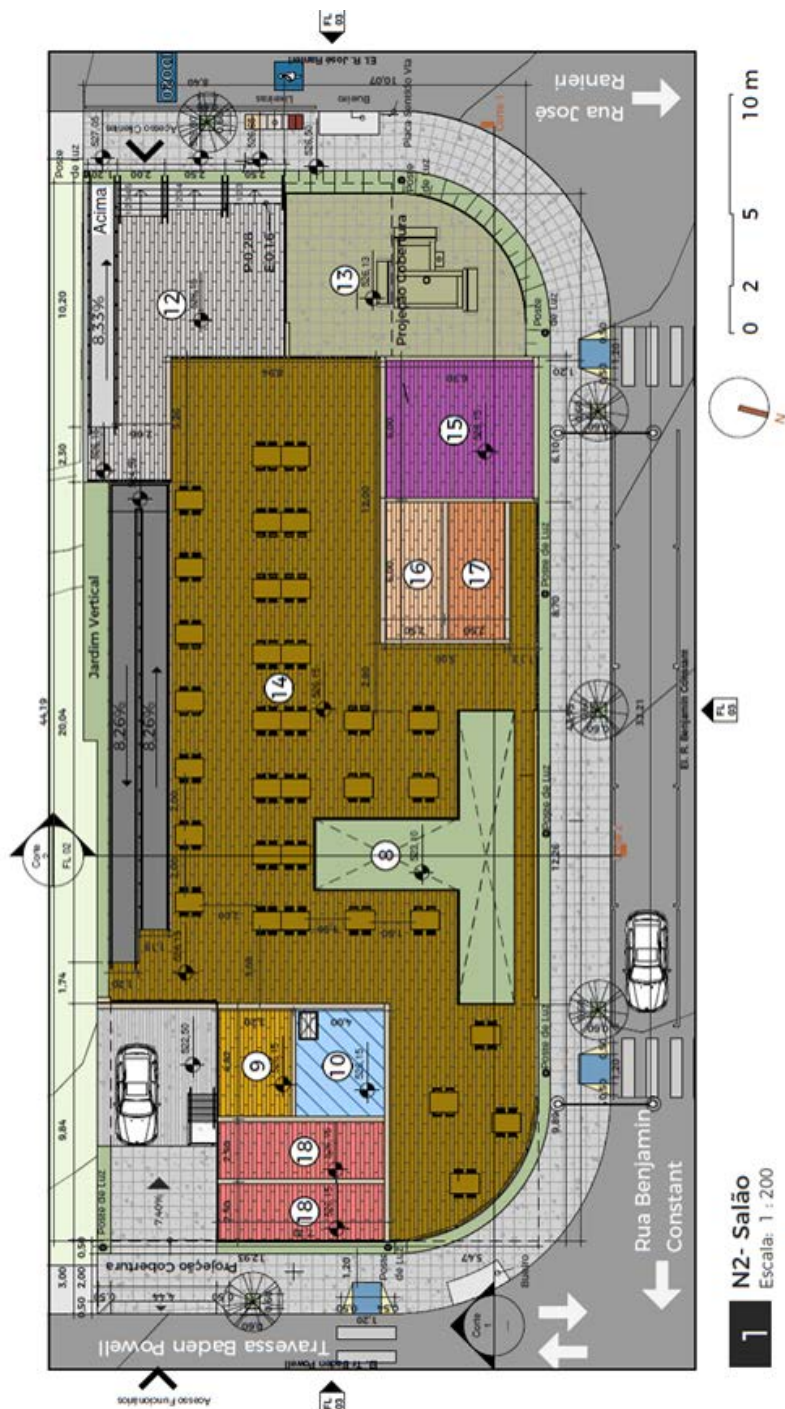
Planta Salão. Fonte: Elaborado pelo autor (2023).
